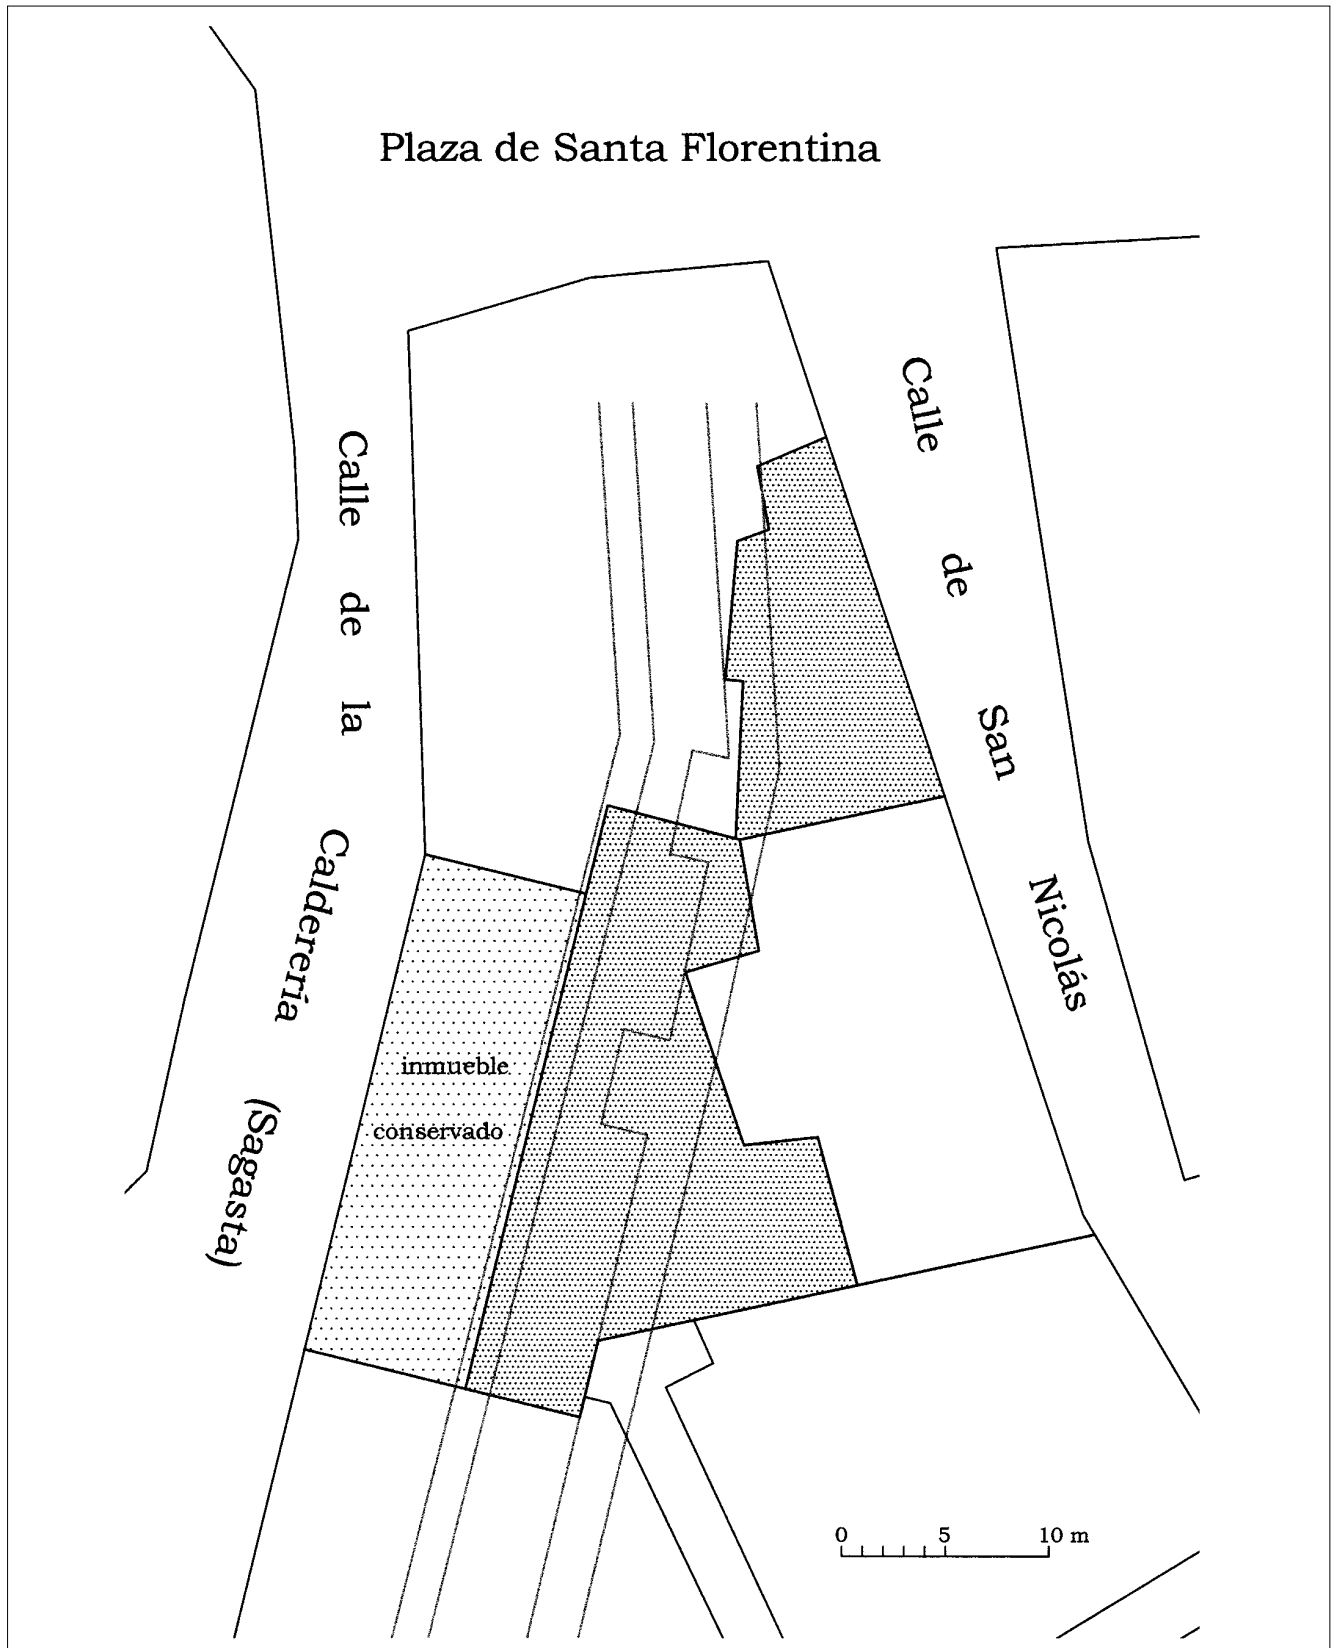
Planimetría de los solares supervisados en las calles Sagasta y San Nicolás
